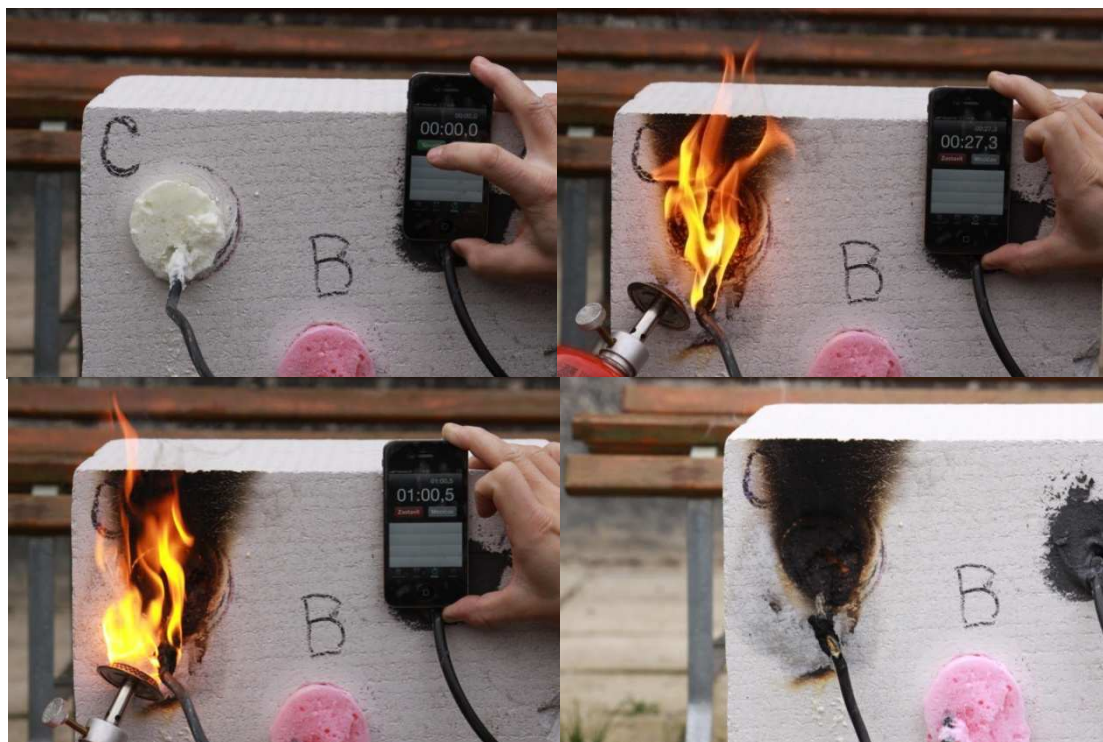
10 Montážní pěna zkoušena plamenem [foto autora]
